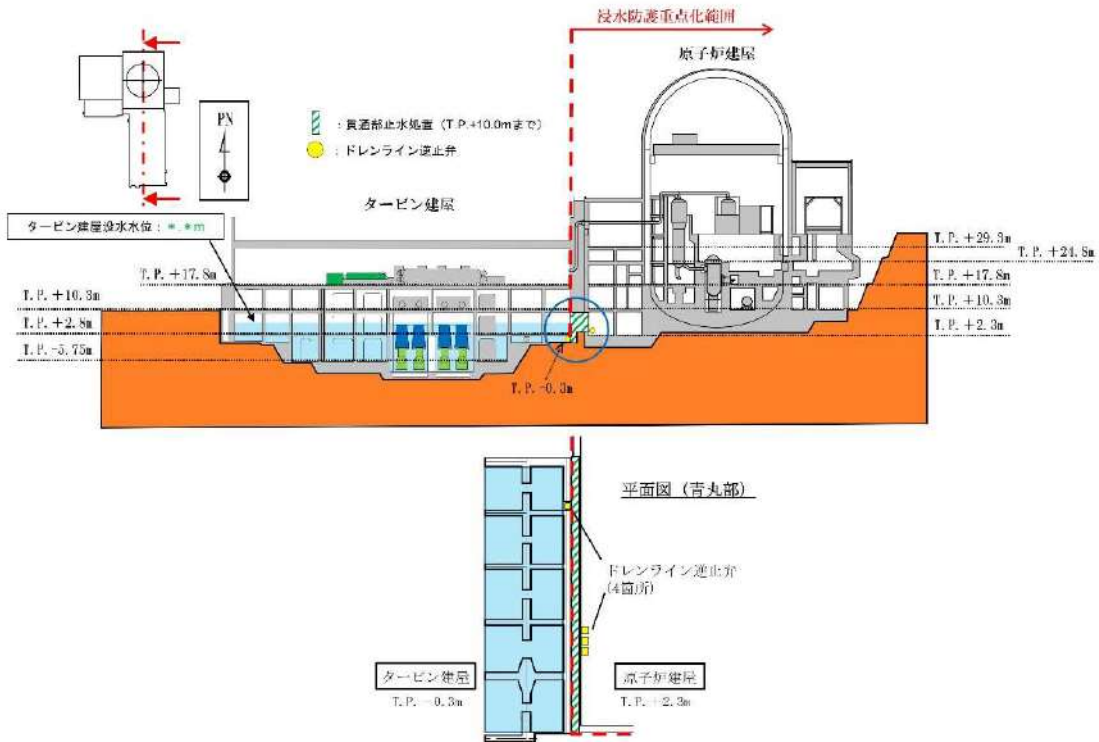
3号炉原子炉建屋と3号炉タービン建屋の境界に設置するドレンライン逆止弁の配置図
